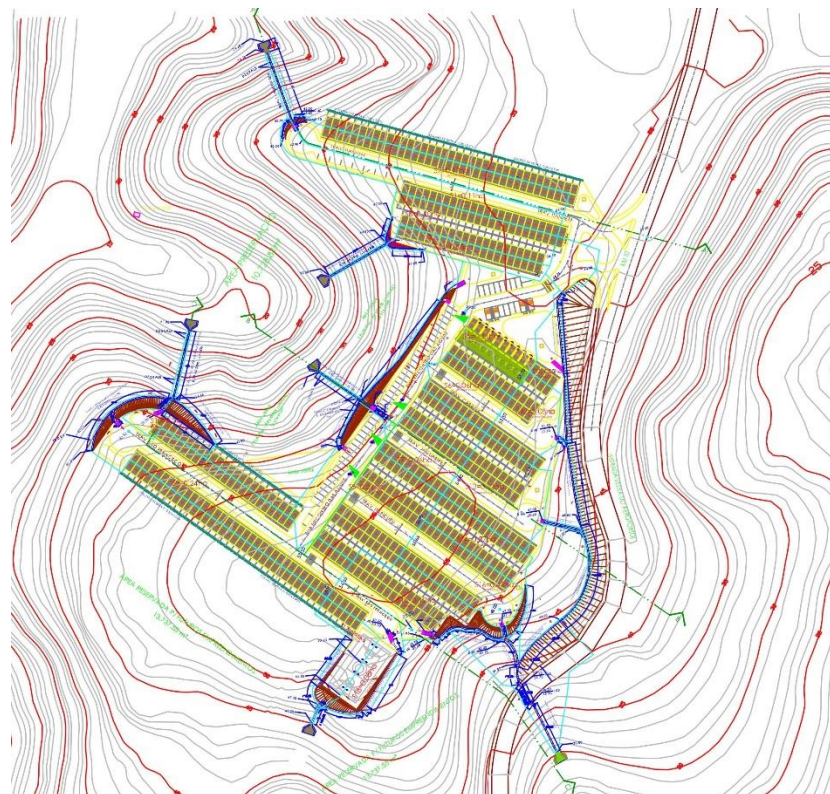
Planta de Instalações Hidráulicas (primeiro projeto)
